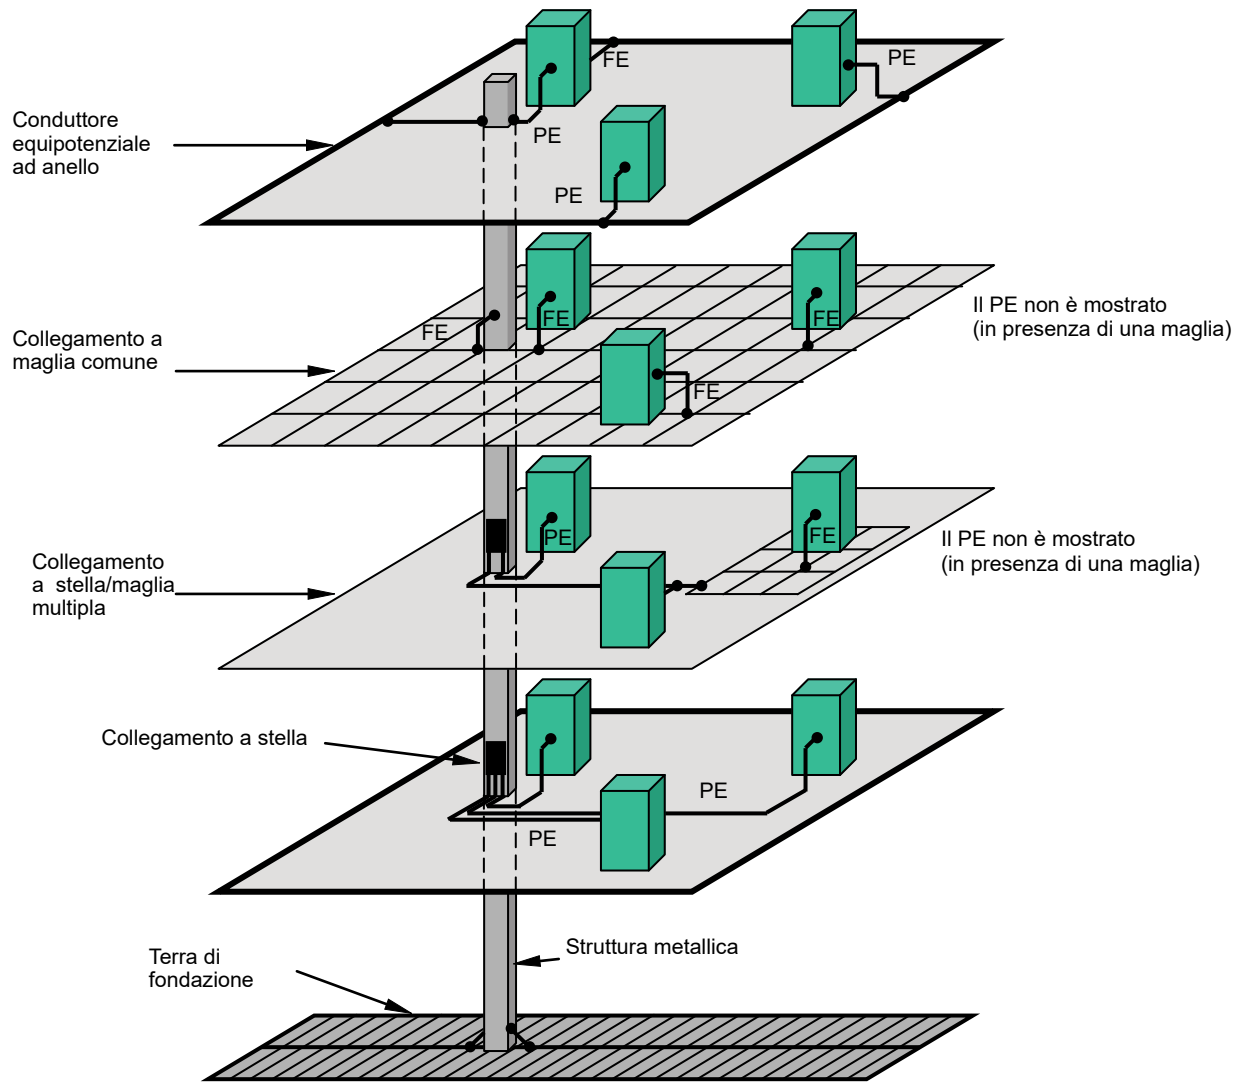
R14 – Esempio di sistema di collegamento equipotenziale in una struttura senza LPS
